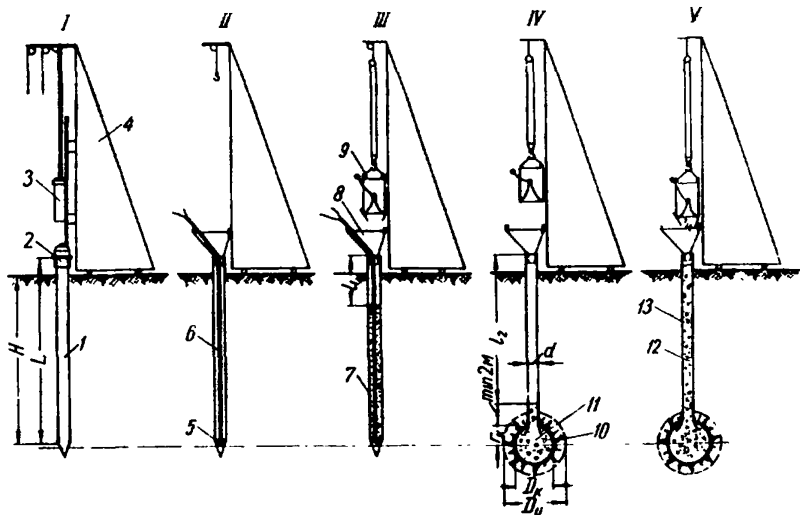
Схема устройства трубобетонных свай с камуфлетной пятой;
